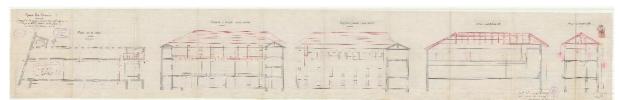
Giuseppe Tonta, *Progetto sopraelevazione dell'infermeria al 2° piano dell'Ospedaletto Santa Filomena in Torino, Via Cottolengo n° 24*, 1903 (ASCT, Progetti edilizi, 1903/166)
